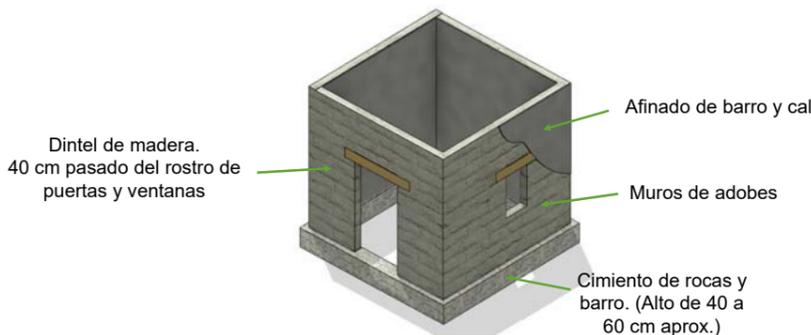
Modelo y elementos constructivos de vivienda a base de adobes. (Fuente: Carlos E. Acual, 2021)
